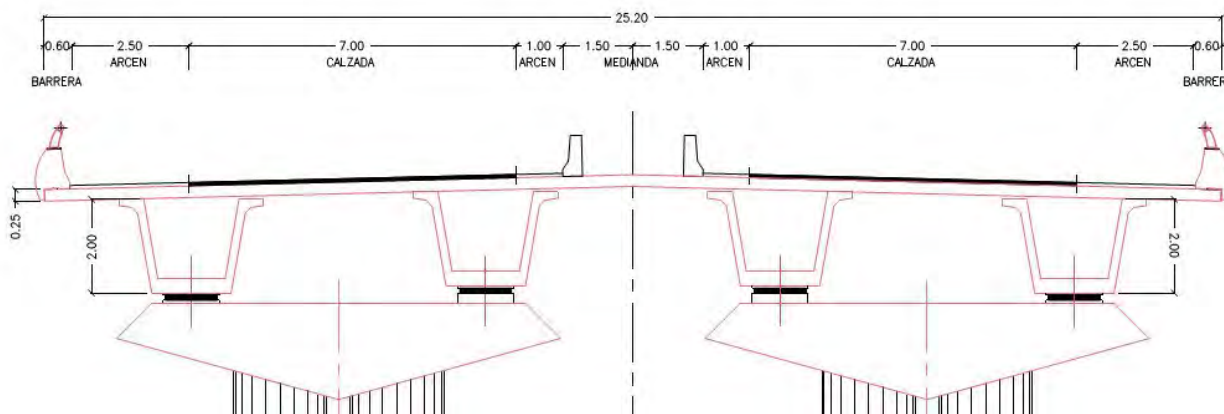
Alzado del puente de Ferrol, en España, con vigas artesas prefabricadas y luces de 45 m
